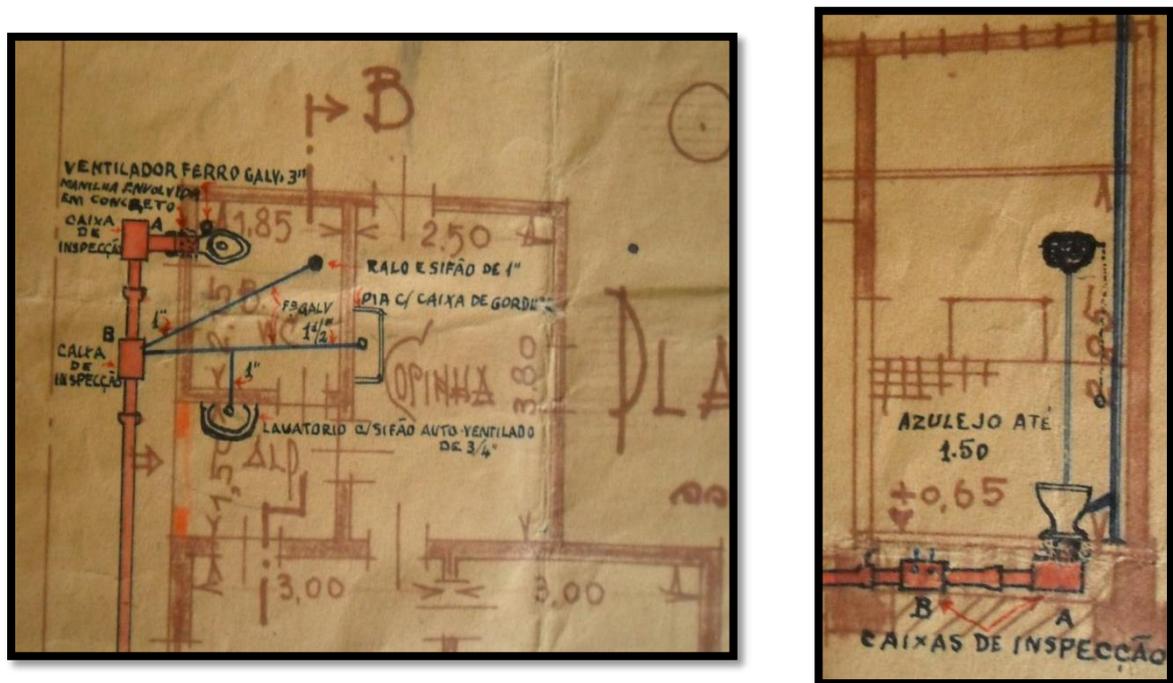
Planta de instalação Hidráulica. Em destaque: a ampliação da planta anterior (Imagem nº 26). Acervo: APPMCG, ano de 1938
